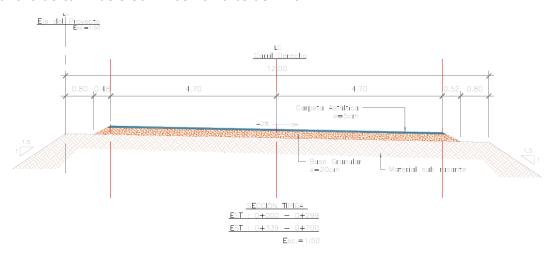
Sección Transversal Típica de las Aproximaciones
